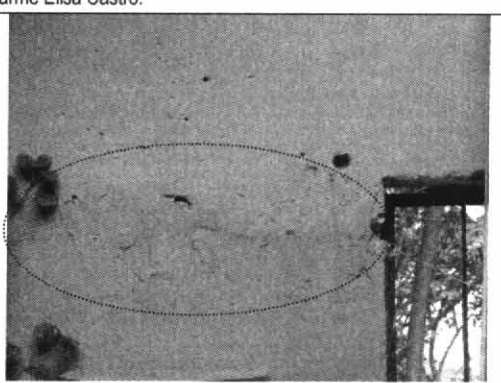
Grietas observadas en el muro exterior del costado norte, además de reparaciones de antiguas grietas en la vivienda de la referencia.
